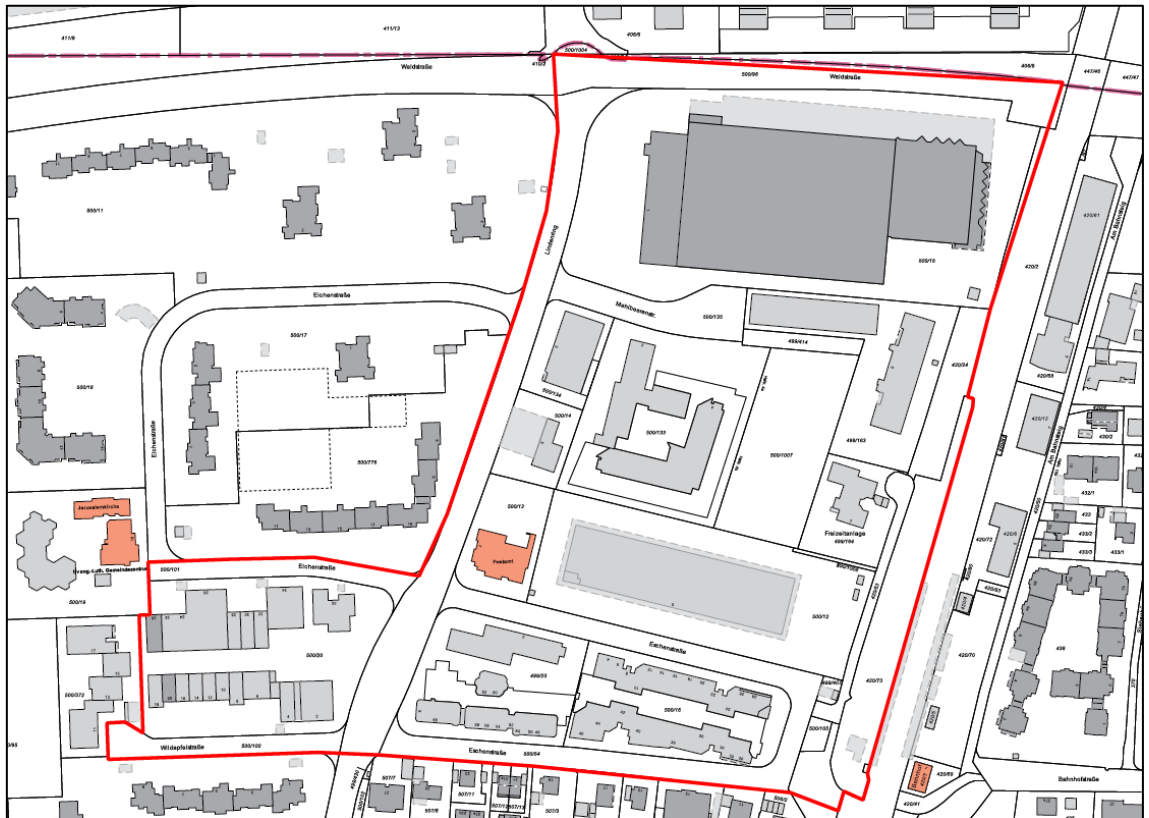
Lageplan mit Kennzeichnung des Plangebiets.
